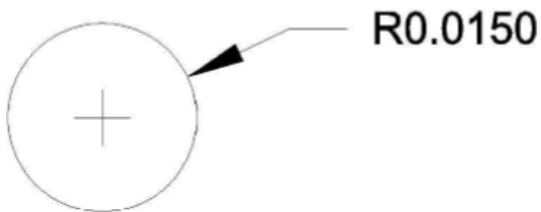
Vista en planta del eje de la pila (medidas en metros). Elaboración propia
